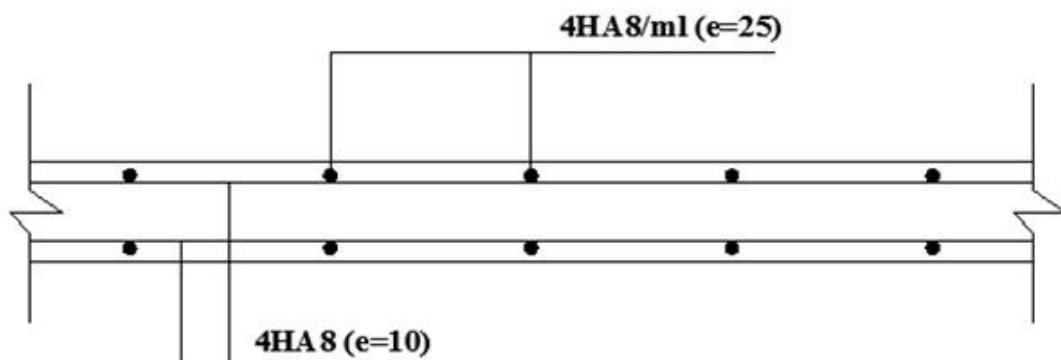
Coupe A-A Ferrailage de l'acrotère.
